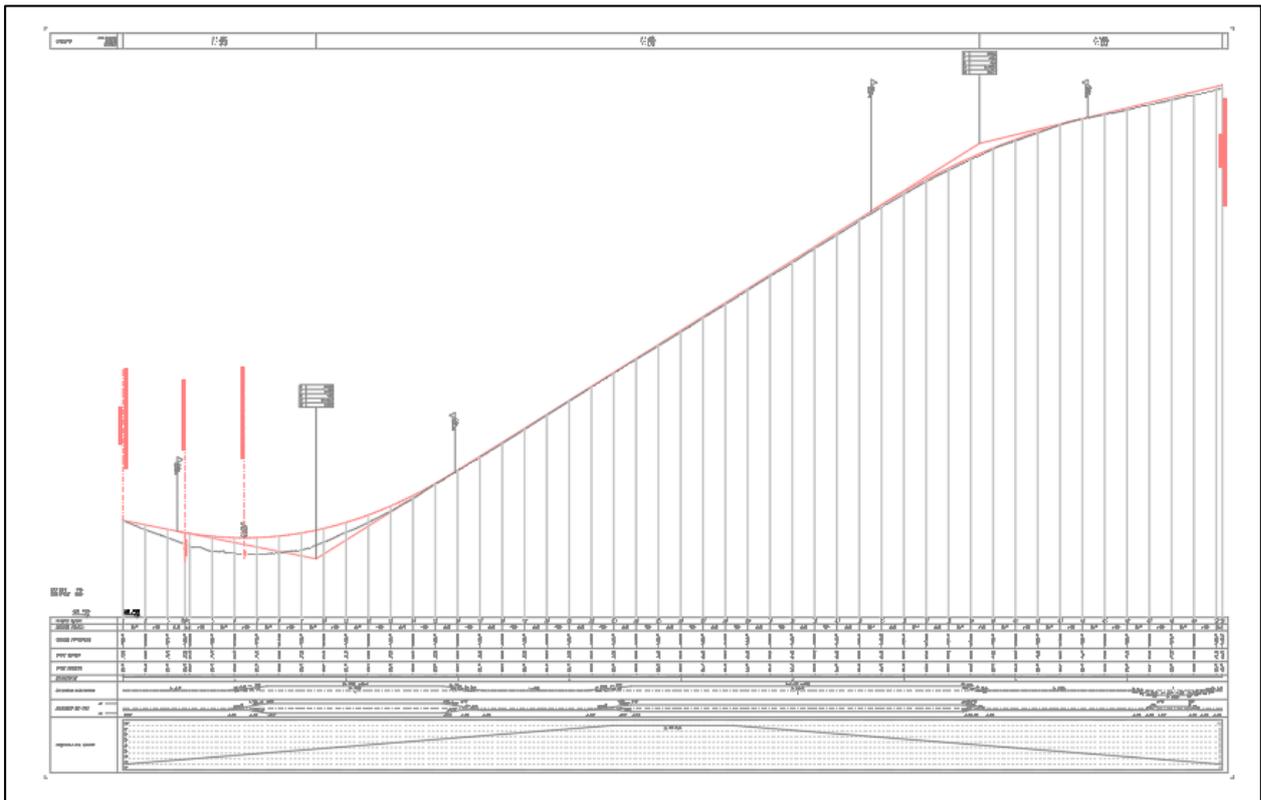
Profilo longitudinale del tratto di adeguamento in sede
